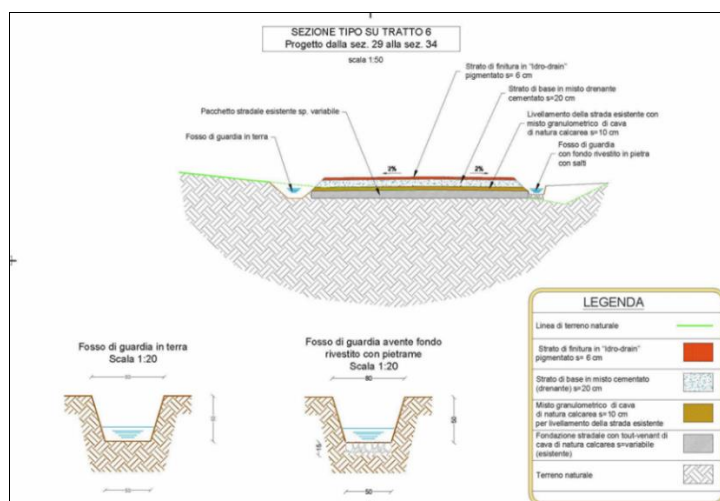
Sezione tipo stradale in corrispondenza dei tratti di elevata pendenza
